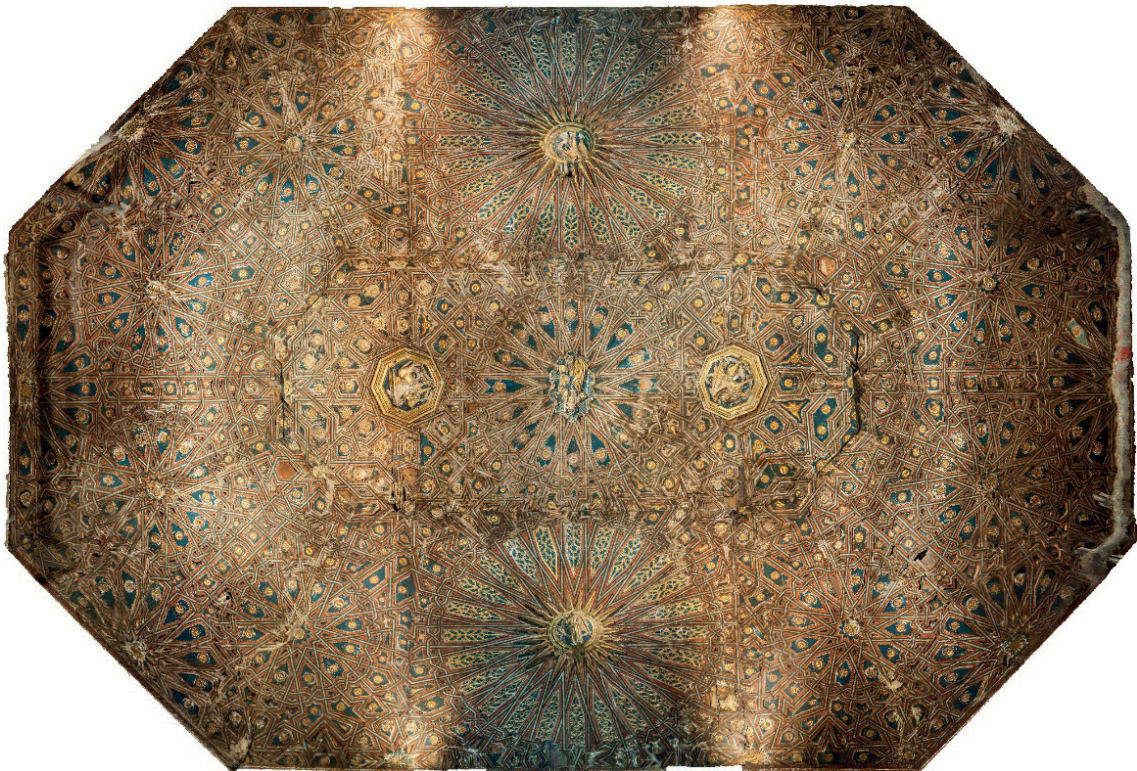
Ortofoto del artesanado visto en planta. Obtenido a partir del modelo generado por fotogrametría digital
